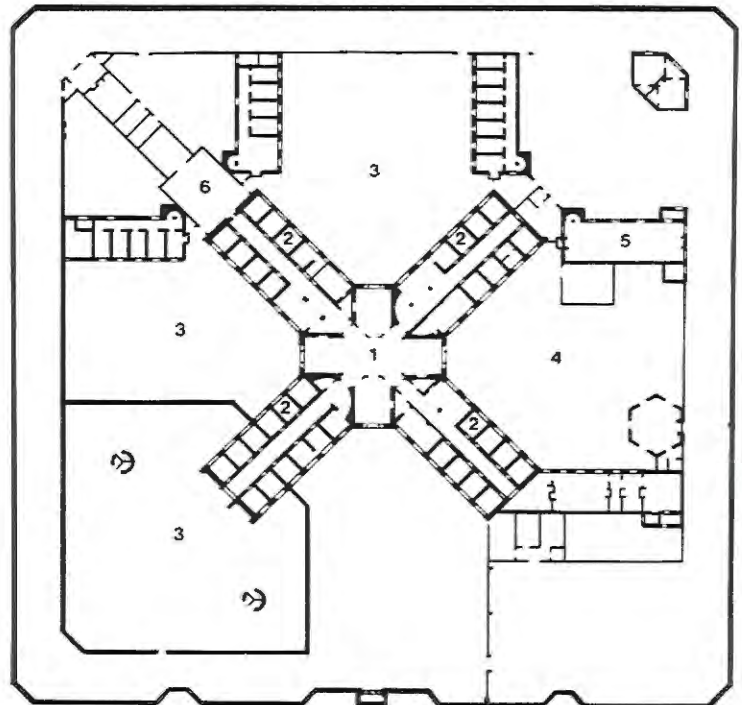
Planta da prisão Bridewell, em Edinburg, desenhada por James Adam, 1791-95.
